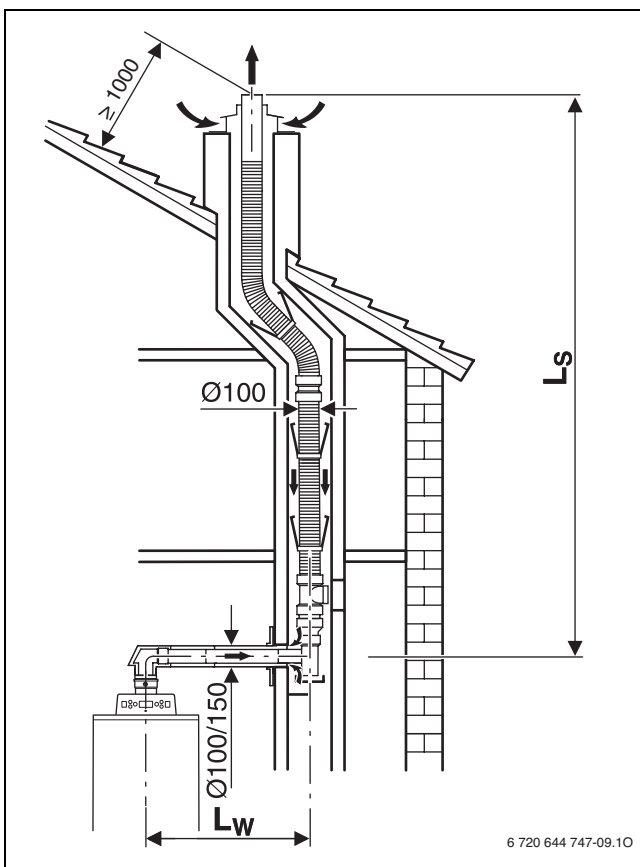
Abgasführung im Schacht flexibel ($C_{93(x)}$)
